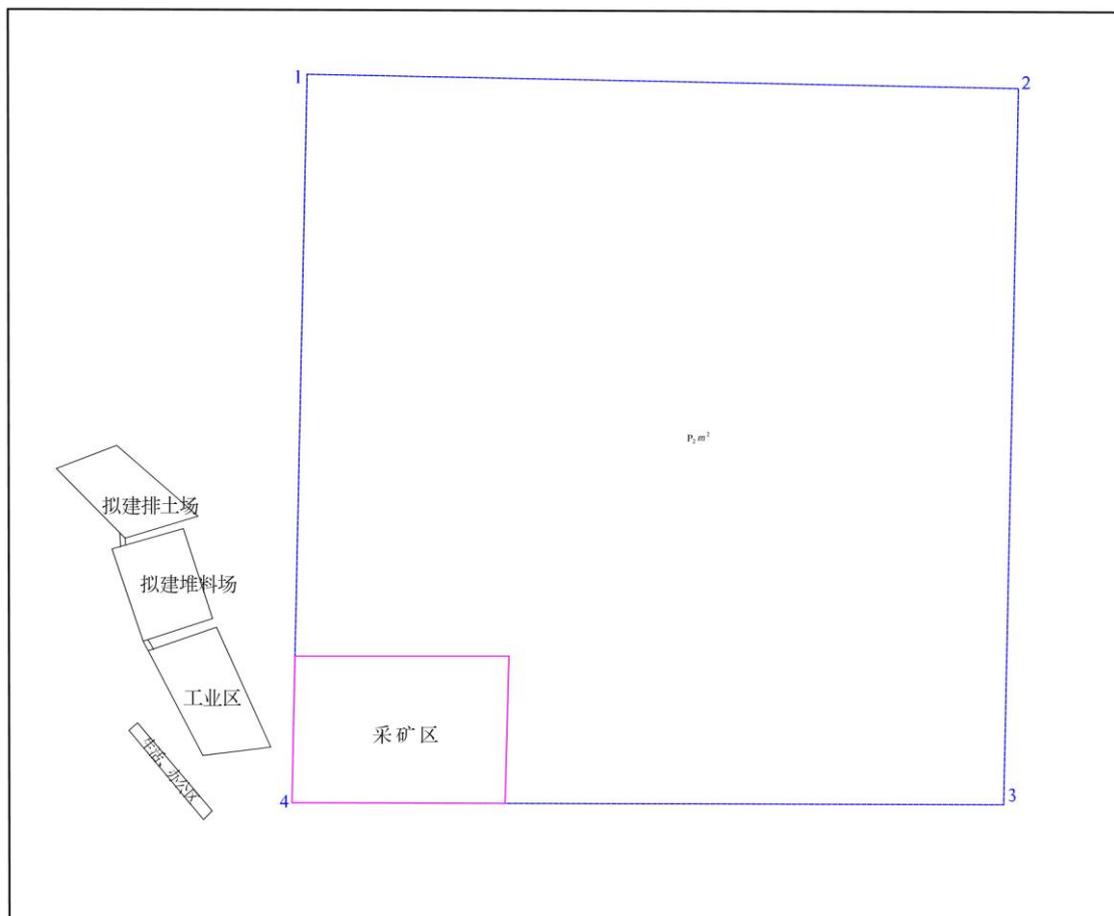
吾湖洒牧场砂石矿总平面布置示意图
